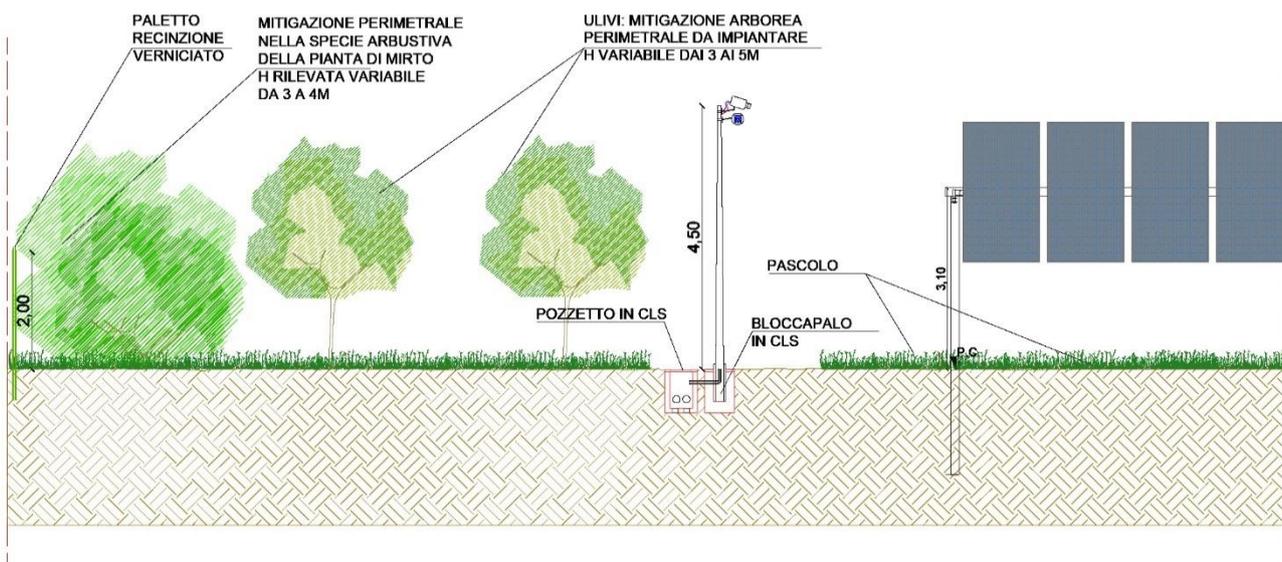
Dettaglio recinzione e mitigazione perimetrale
